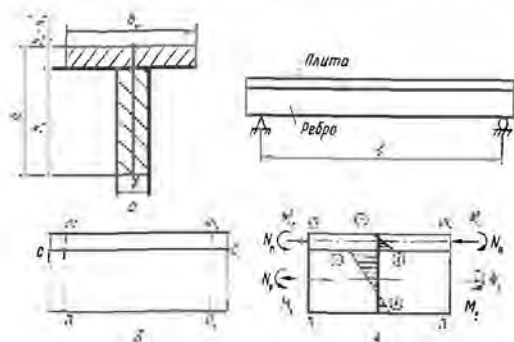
К расчету балки комбинированного сечения: а – поперечное сечение и расчетная схема балки; б – элемент балки; в – схема усилий в ребре и плите балки и эпюра напряжений на участке  $m-m$
